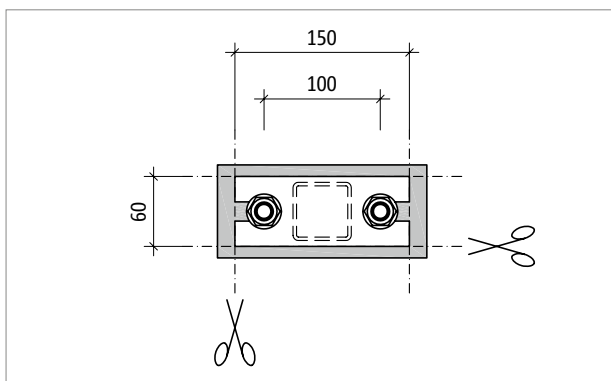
Schöck Isokorb® T type S-V : dimensions après découpe du corps isolant
